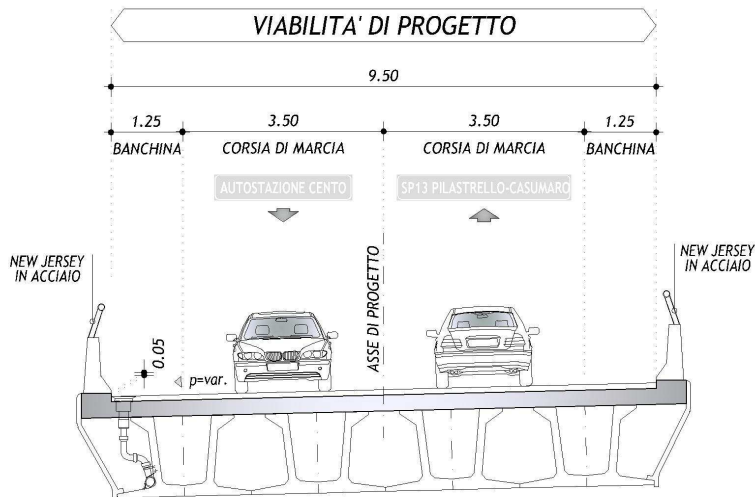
SEZIONE TIPO SU VIADOTTO
